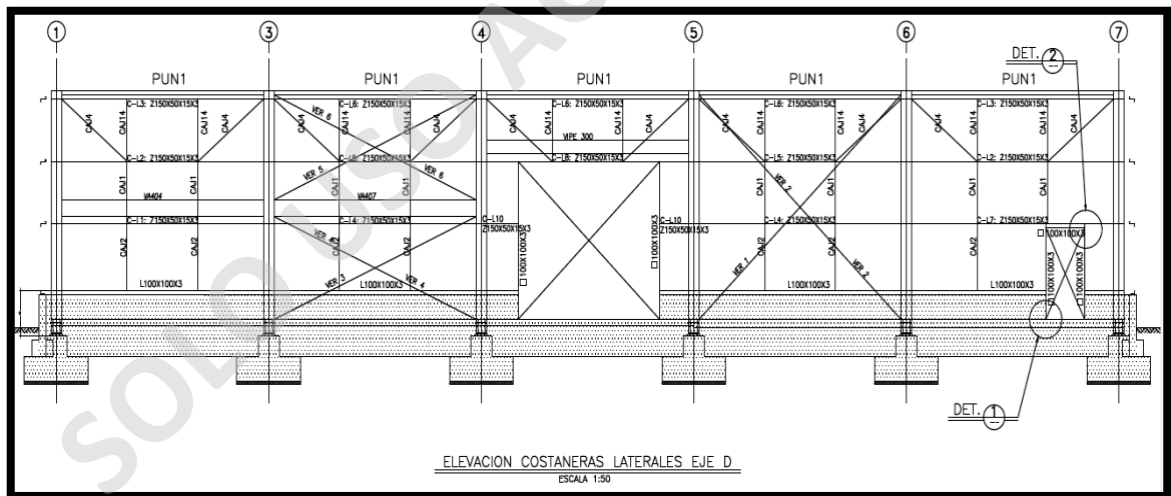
Elevación de Eje D Colgadores ODR Ingeniería y Montaje.
